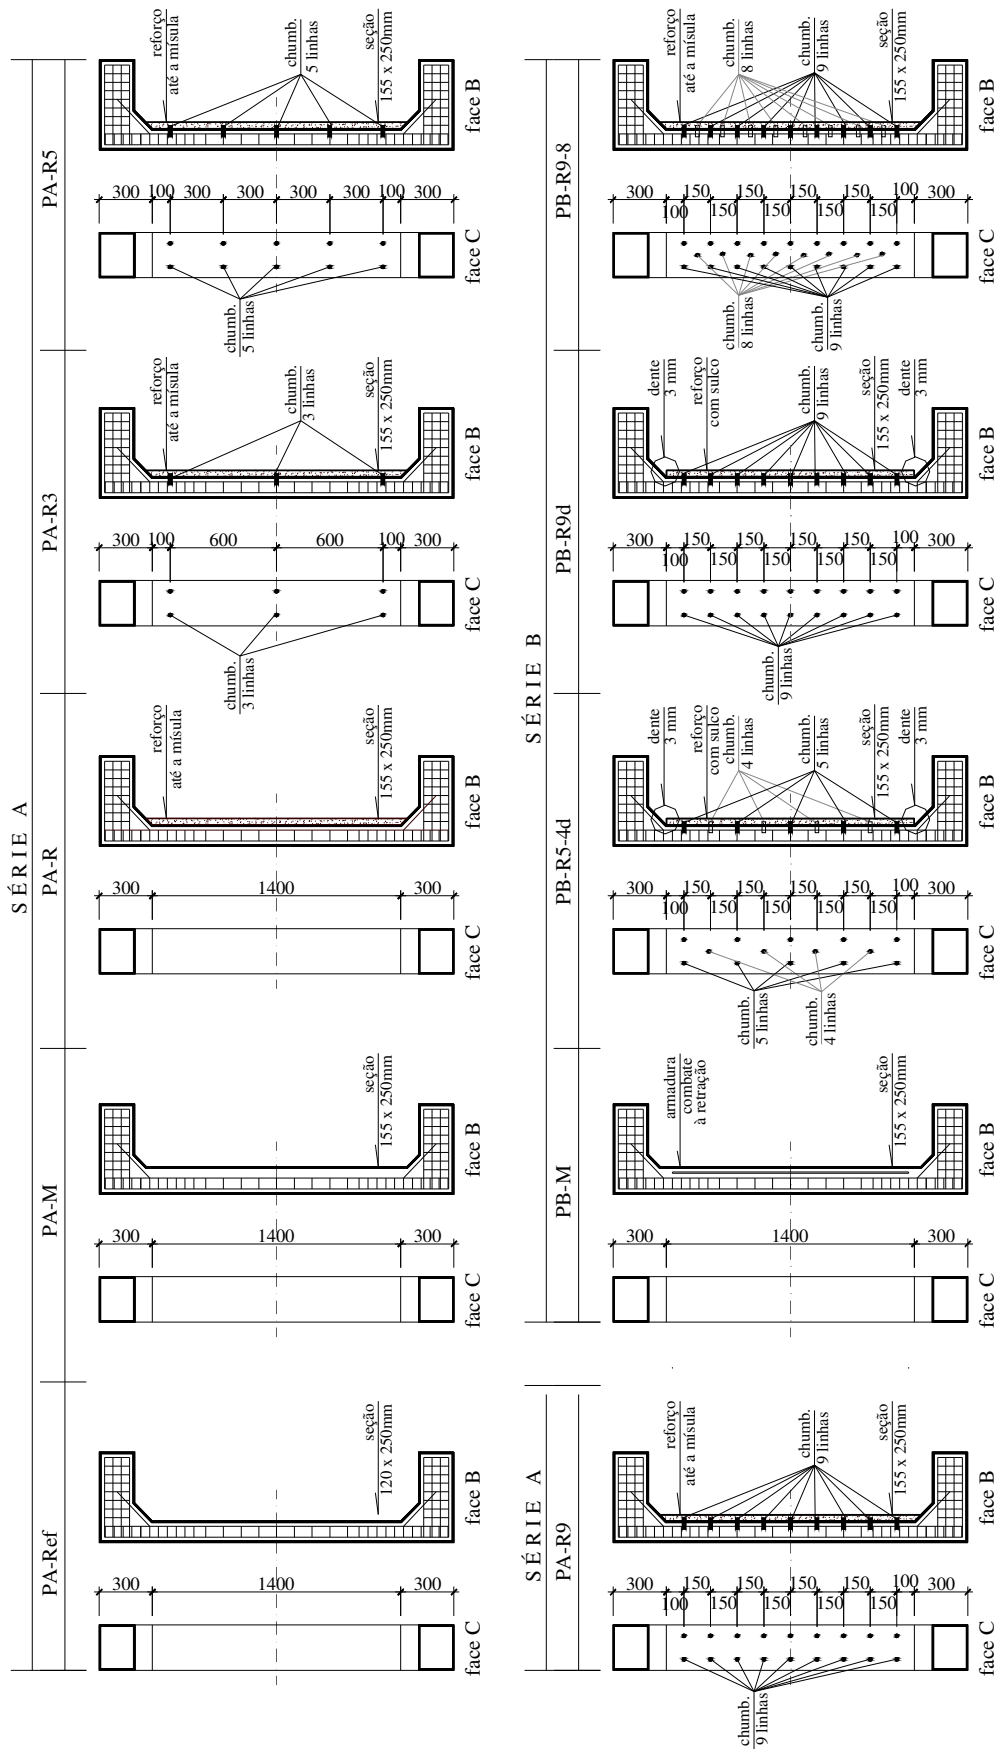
Detalhamento dos pilares ensaiados (SAHB, 2008)
